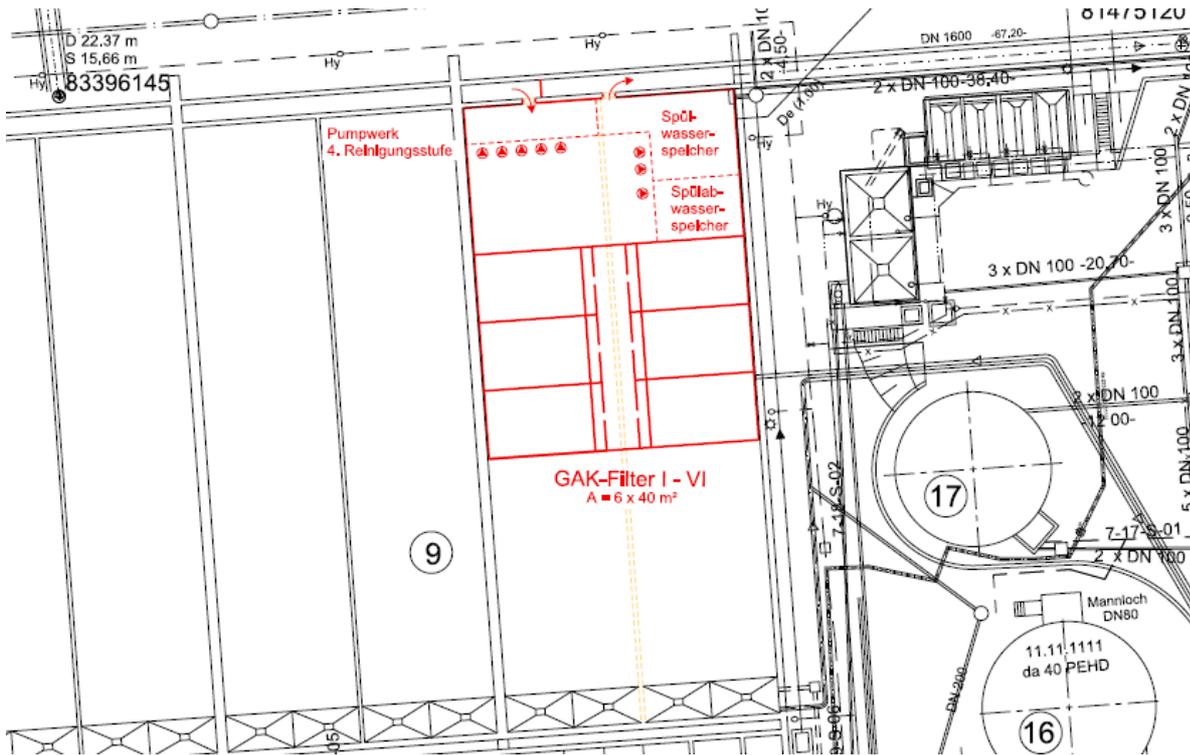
Lageplanausschnitt Variante 2: GAK-Filtration
